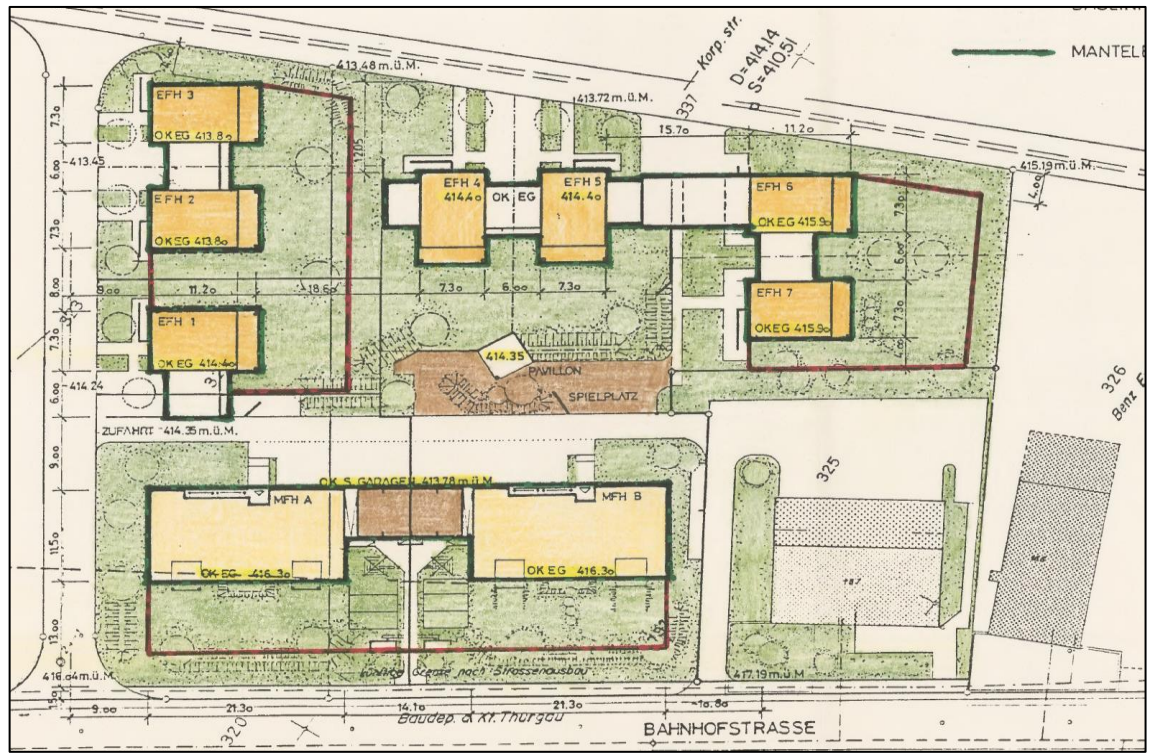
Ausschnitt Arealüberbauungsplan Tiefenbach (1986). Quelle: ÖREB-Kataster
